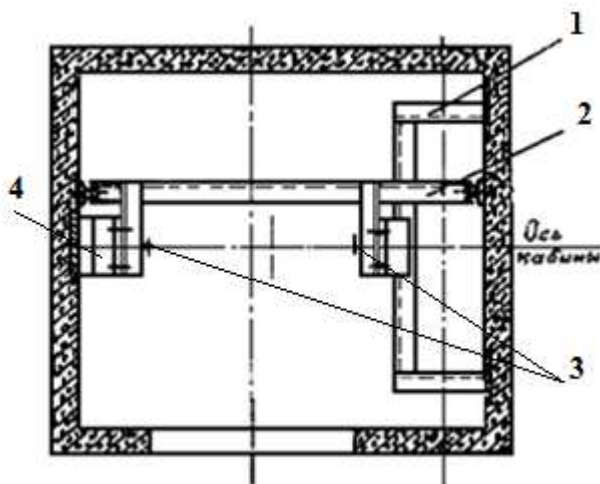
Кондуктор для установки кронштейнов крепления направляющих
